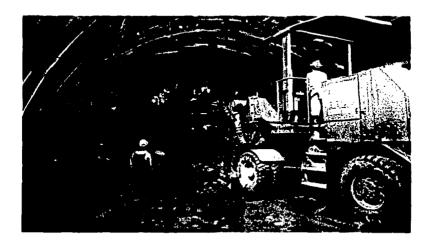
Fotografías de jumbo barrenando una sección de excavación del túnel
